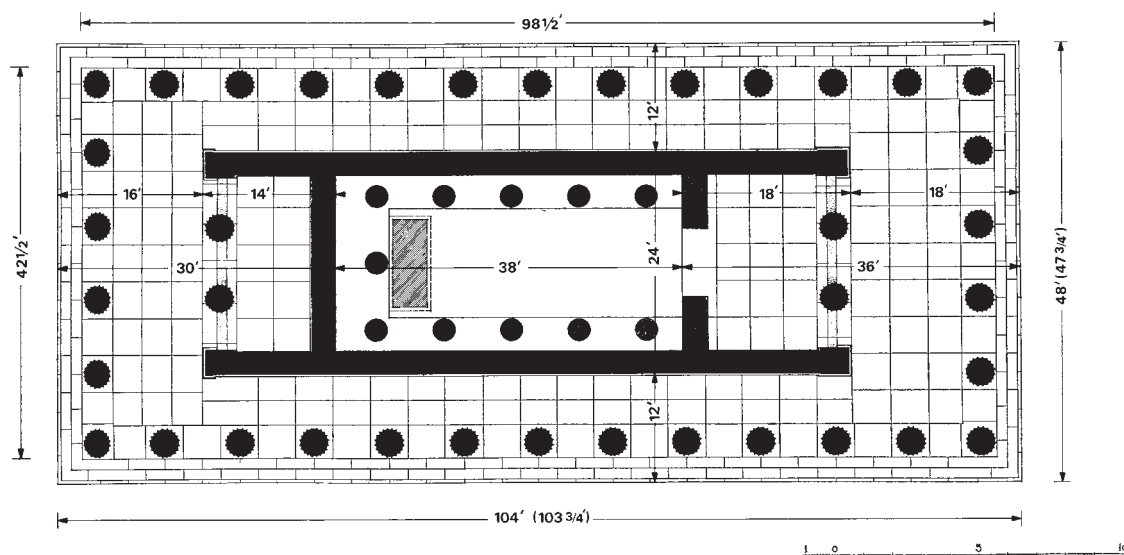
Grundriß des Hephaisteion in Athen (nach Travlos, Maße nach dem Autor).
